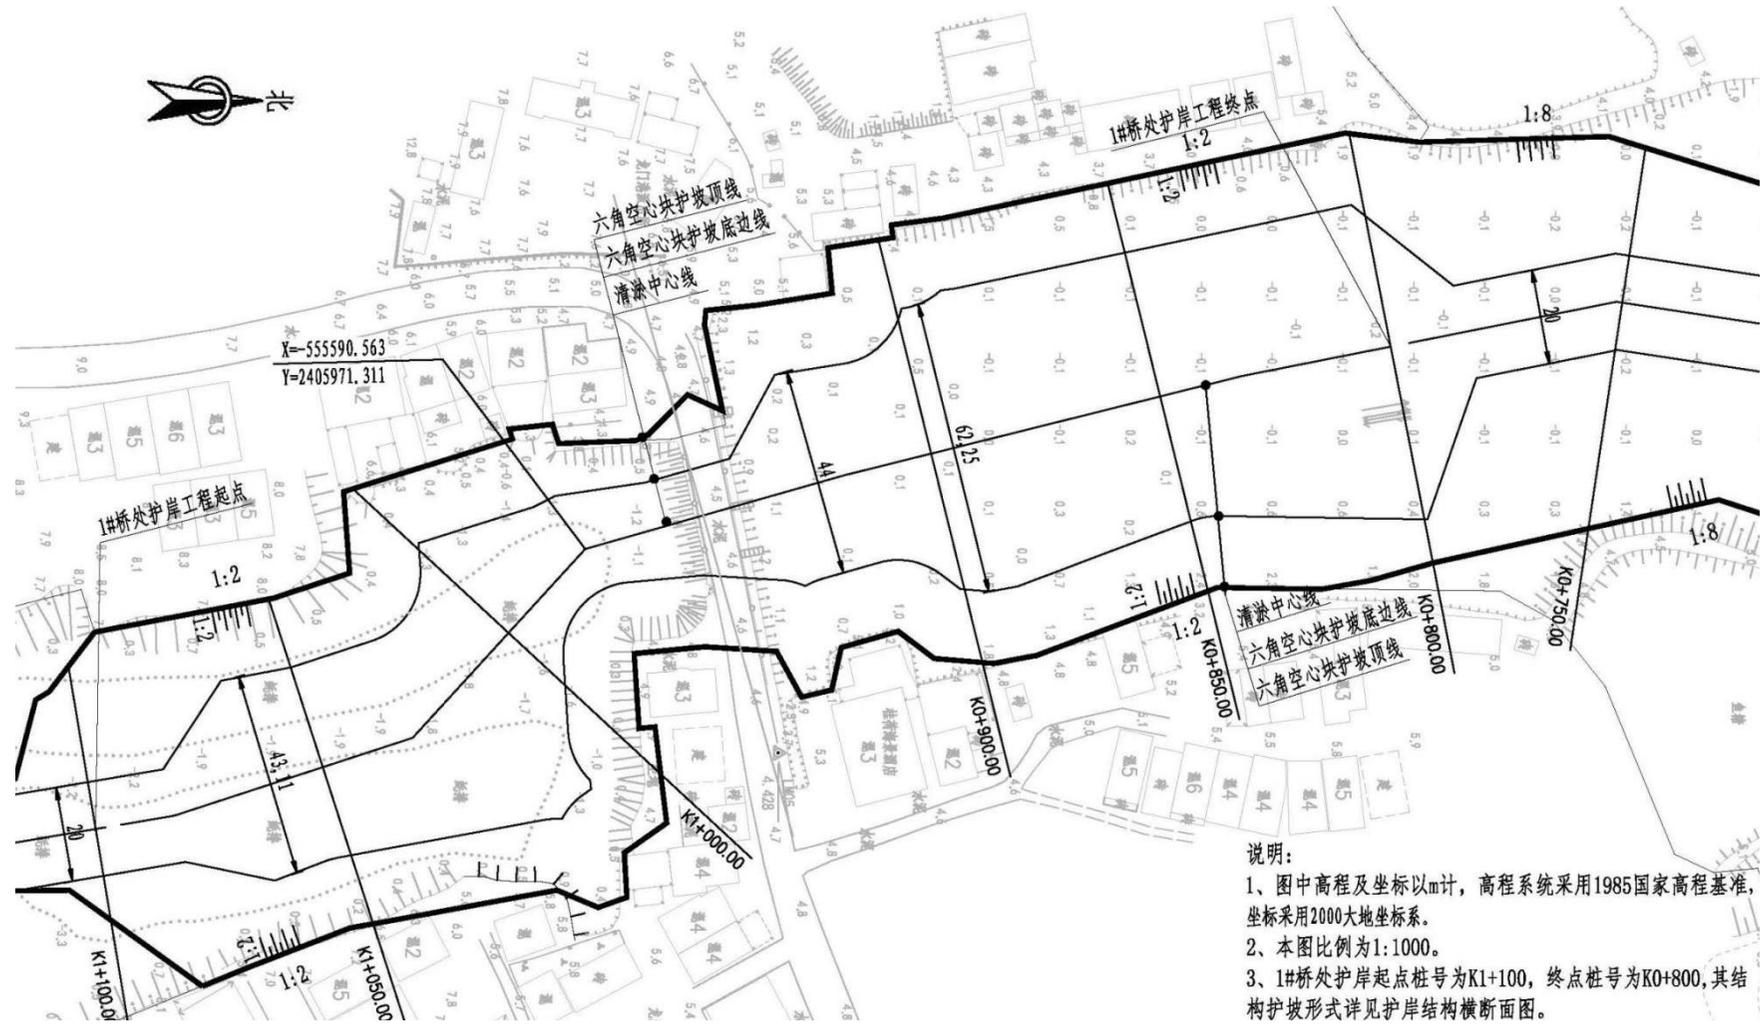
岸线生态整治平面布置图 (1#桥处护岸)
